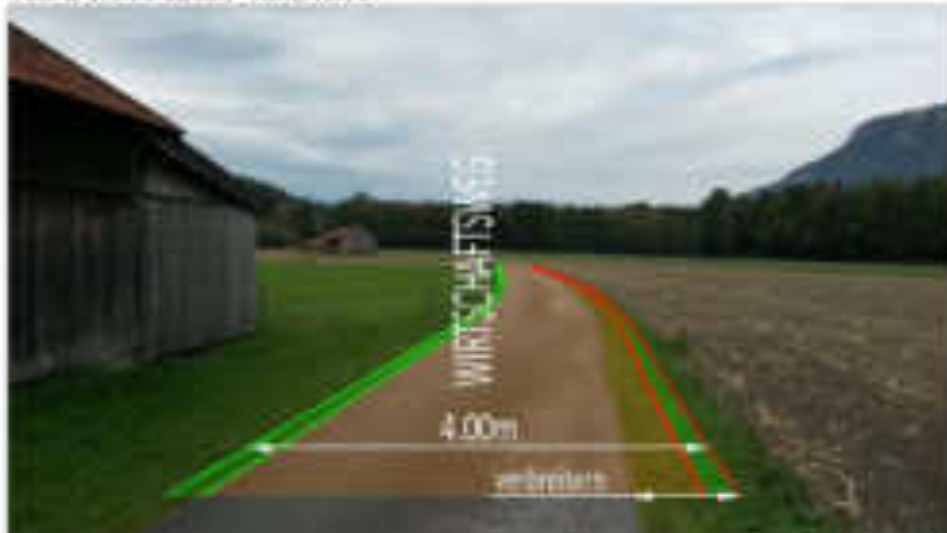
1: Oberaudorf - Abschnitt 1 - Variante
